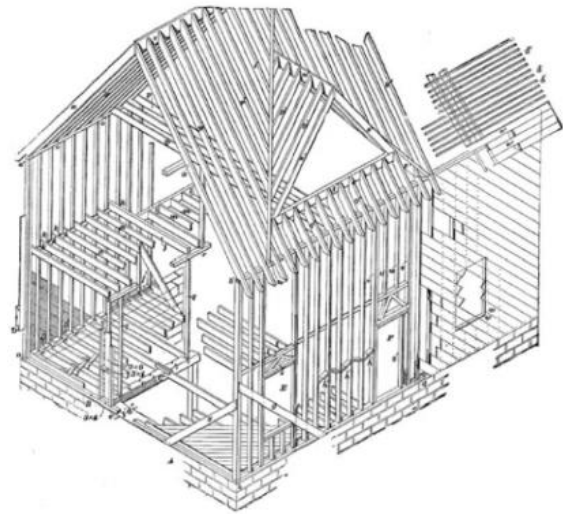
Balloon Frame Americano. Carpentry Joinery Stair Building & C (Scranton, Pennsylvania, 1904).
